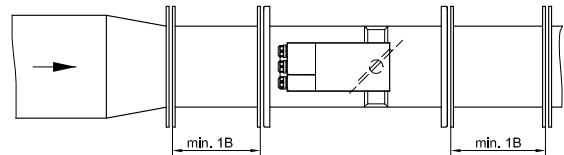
Einbau nach Störstelle, z.B. Reduzierung
